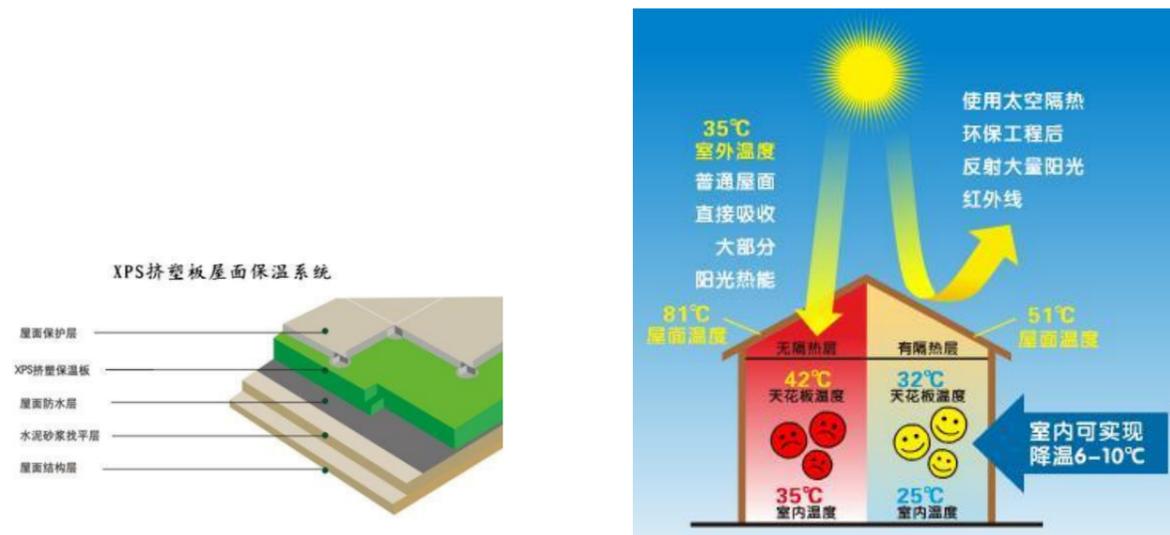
隔热材料屋面与隔热涂料屋面示意图
